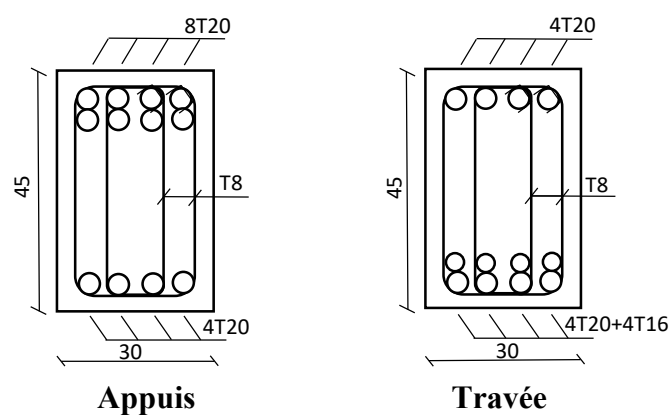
Schéma de ferraillage des poutres porteuses.
